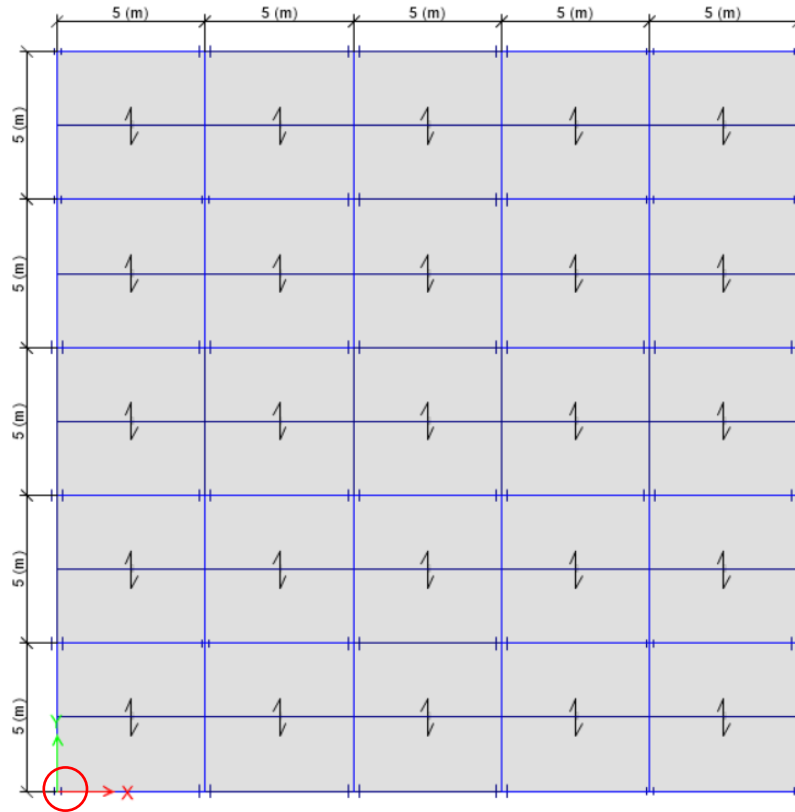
Vista en planta de las estructuras y el punto de control para drifts.
